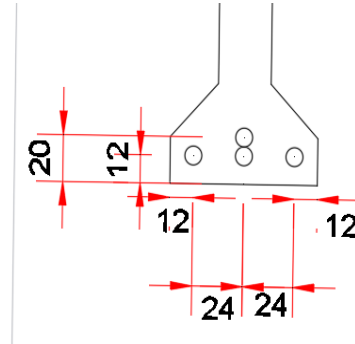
disposition des câbles dans la section d'about
